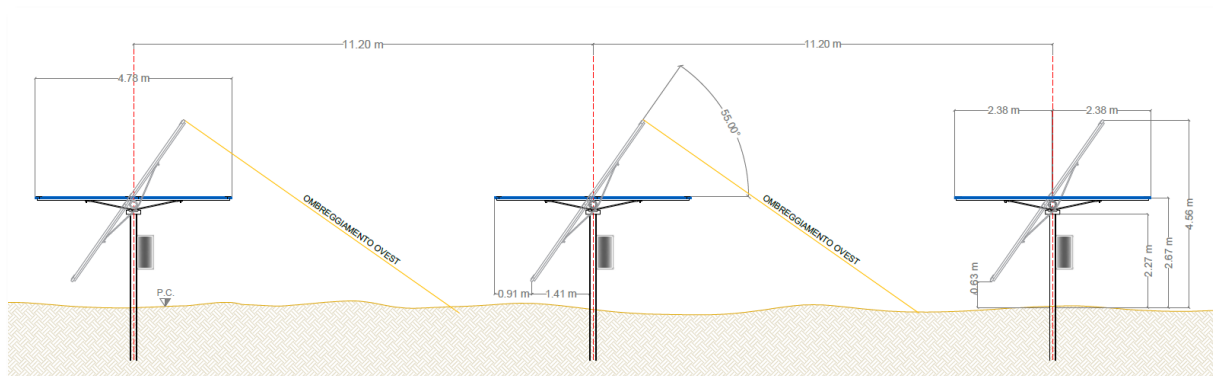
Vista frontale con rotazione di 55° ovest e distanza longitudinale tra le strutture
